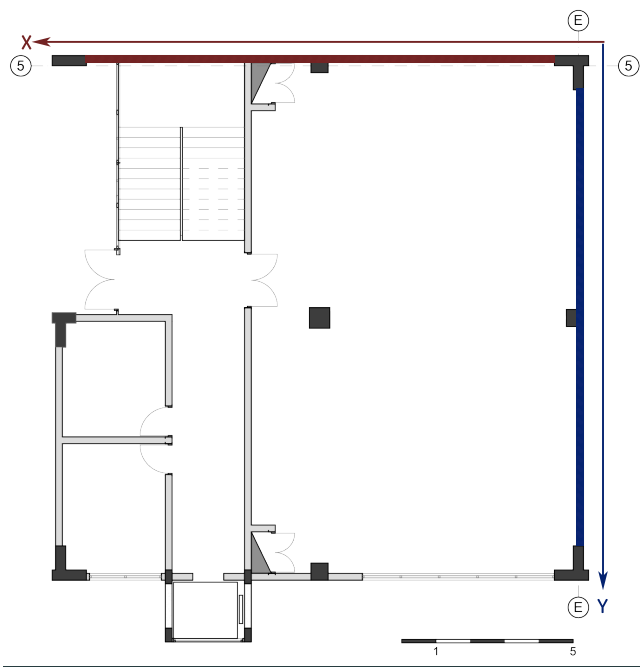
Esquema en planta de ejes para el cálculo de las derivas de entrepiso
